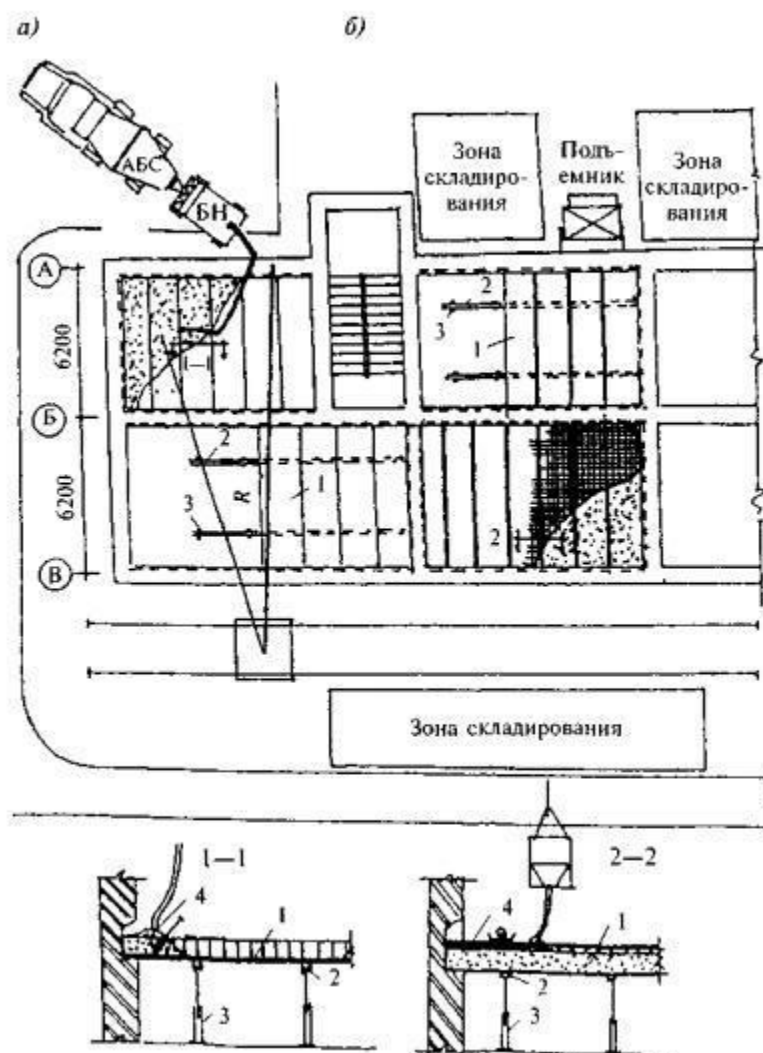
Технология устройства сборно-монолитных перекрытий в несъемной опалубке из железобетонных плит с выпусками арматуры (а) и пенополистирольных плит (б) с последующим омоноличиванием
